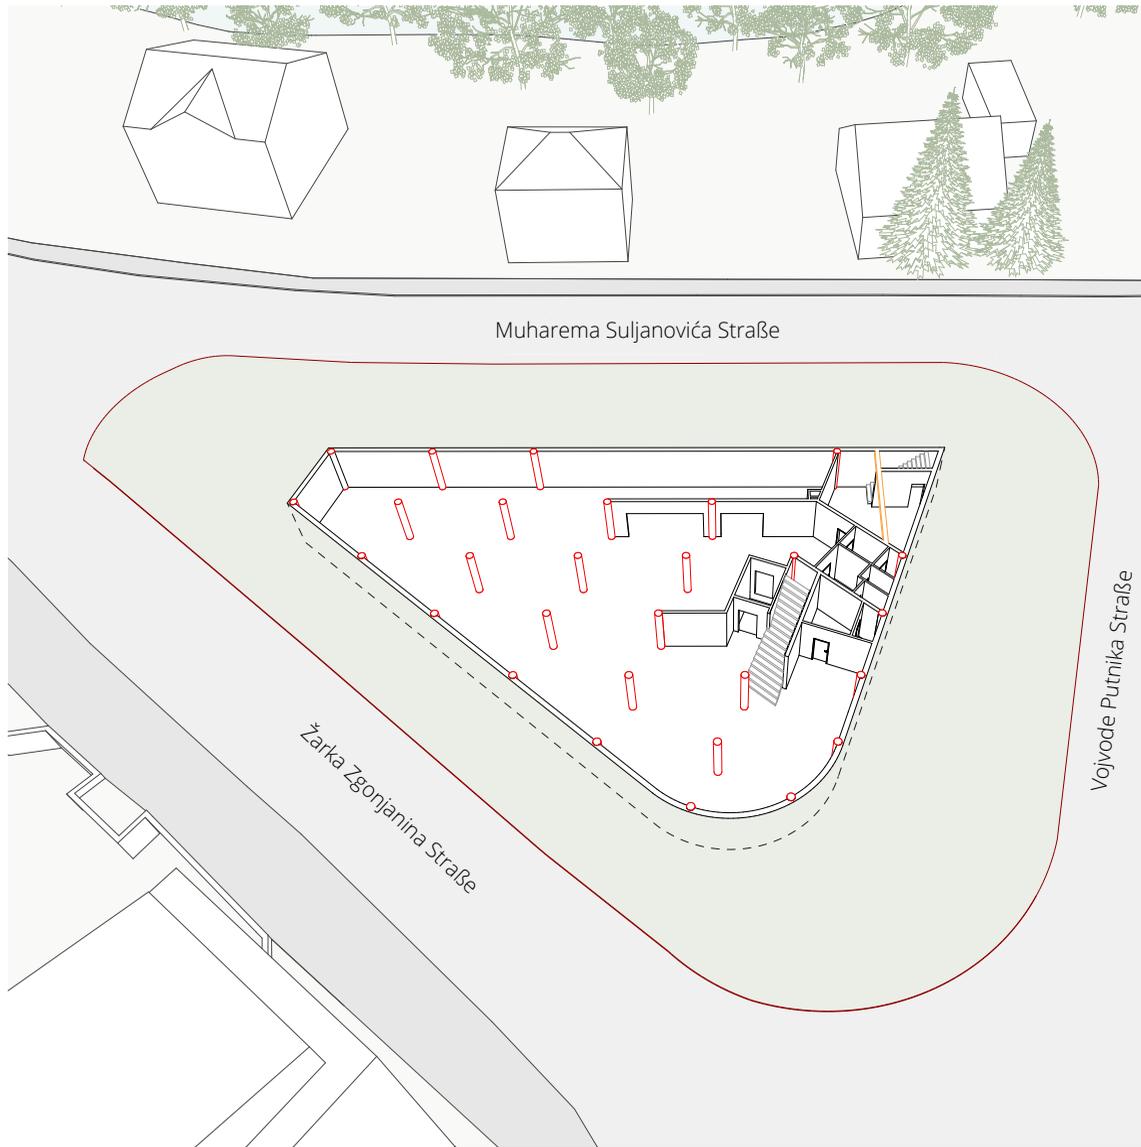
1. Untergeschoß (Kellergeschoß) Bestand_3D
